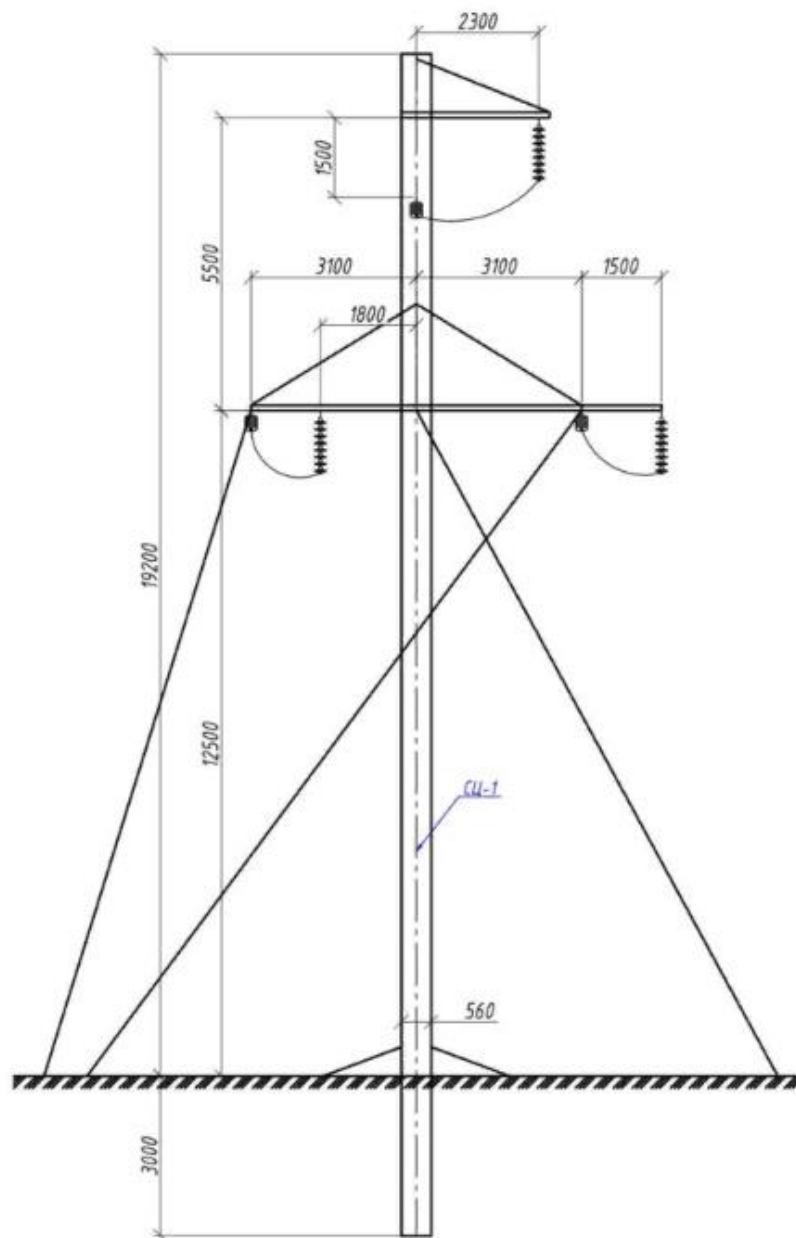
Анкерная железобетонная опора марки УБ 110-1
